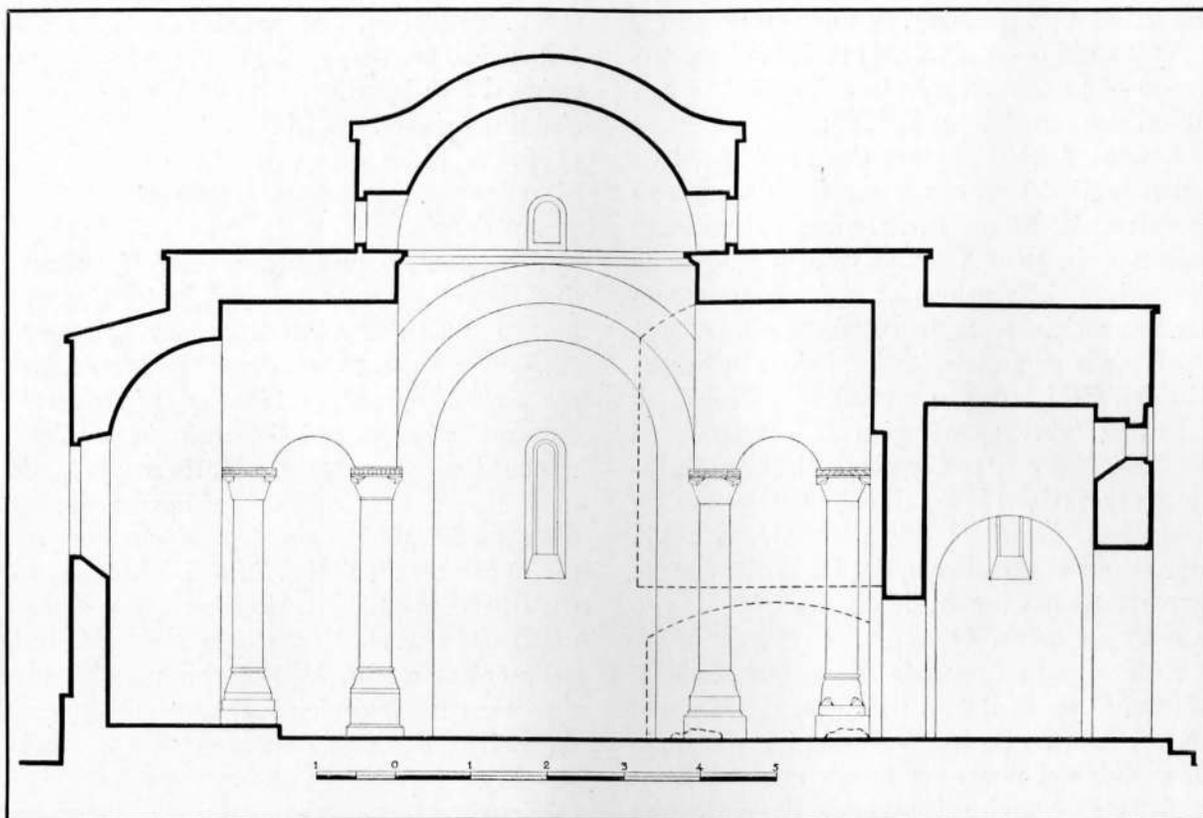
FIG. II - CASTRO, CHIESA A CROCE GRECA: SEZIONE TRASVERSALE
